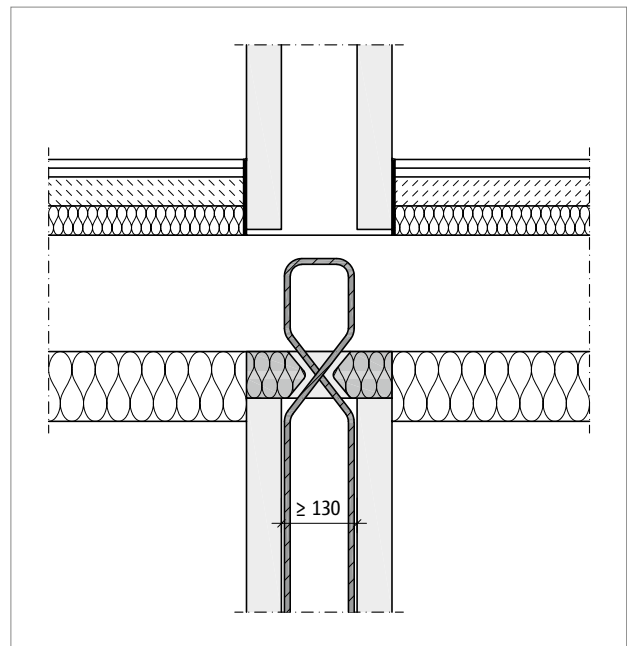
Schöck Sconnex® Typ W: Schematische Darstellung Schöck Sconnex® Typ W bei Doppelwänden und Unterdeckendämmung
